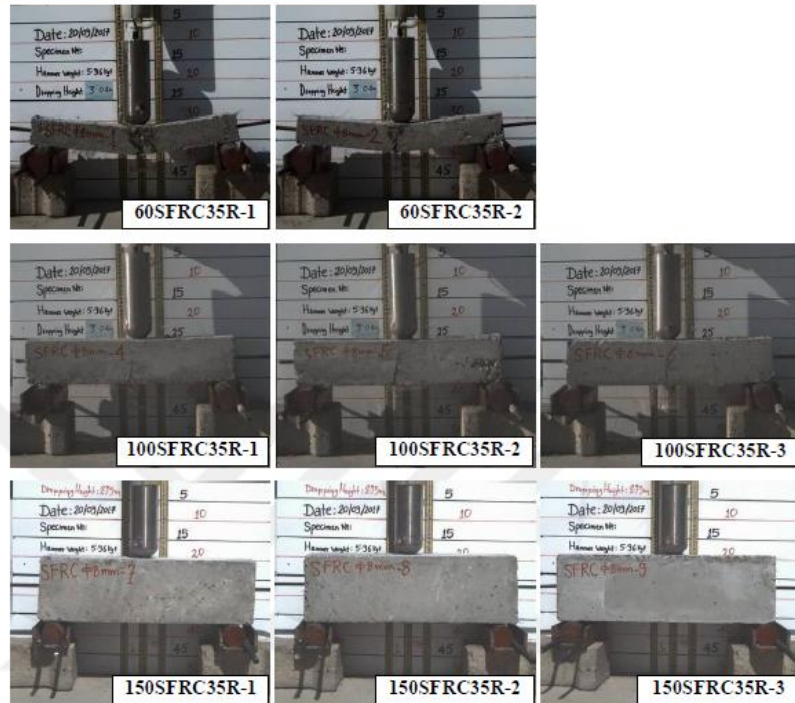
Tek Darbeli Yükleme Testinde 400 mm Düşme Yüksekliğinde Hasar Modları
